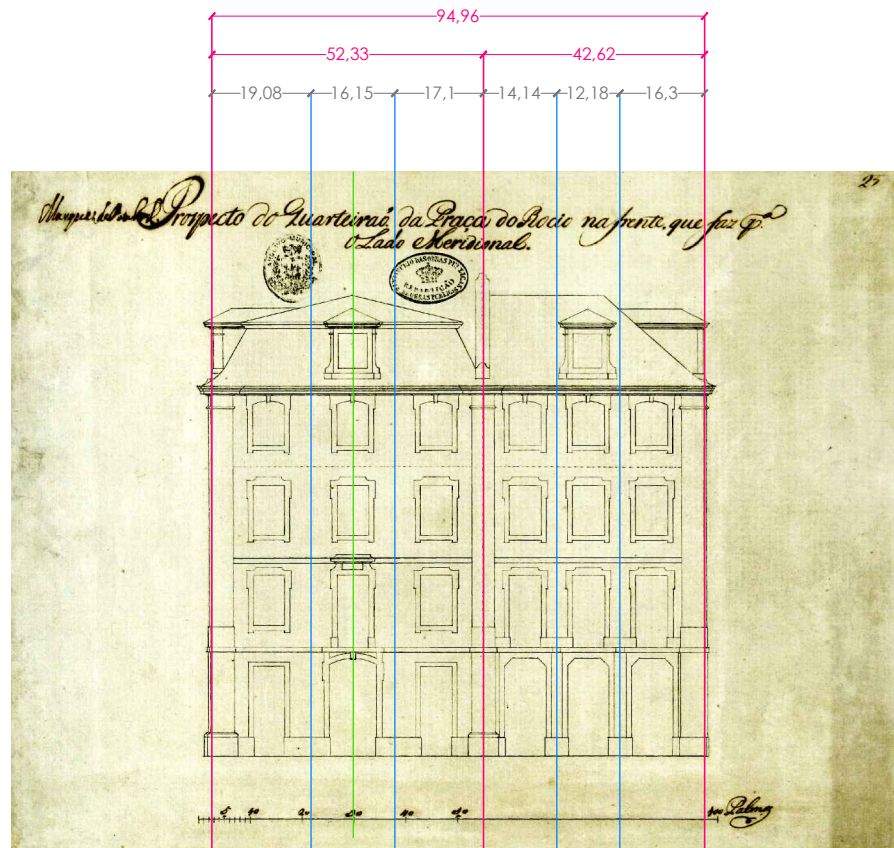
Fachada de la Rua da Betesga, proyecto firmado por el marqués de Pombal.
